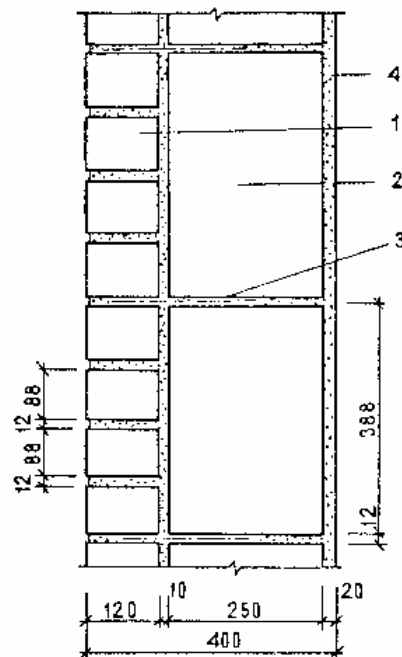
Конструкция кладки из газосиликатных блоков с облицовкой:
